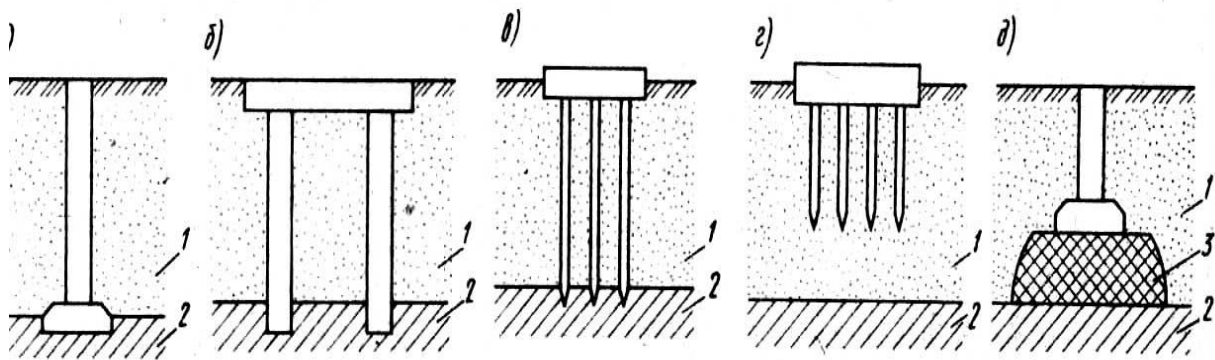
Устройство фундаментов при напластовании грунтов (тип 2):
